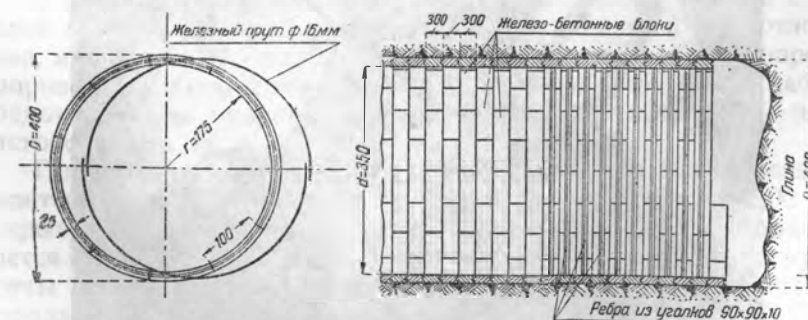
Tunnel из железобетонных блоков системы „Мкалпайн“ в лондонской глине.
